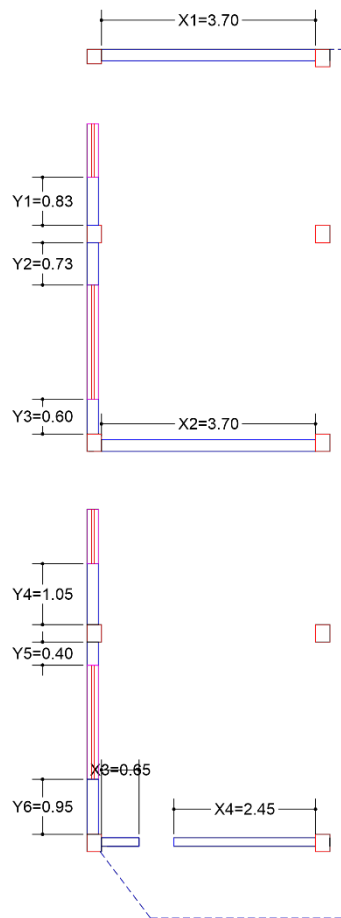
Pabellón A de la I.E. N° 055 María Isabel Rodríguez Urrunaga
